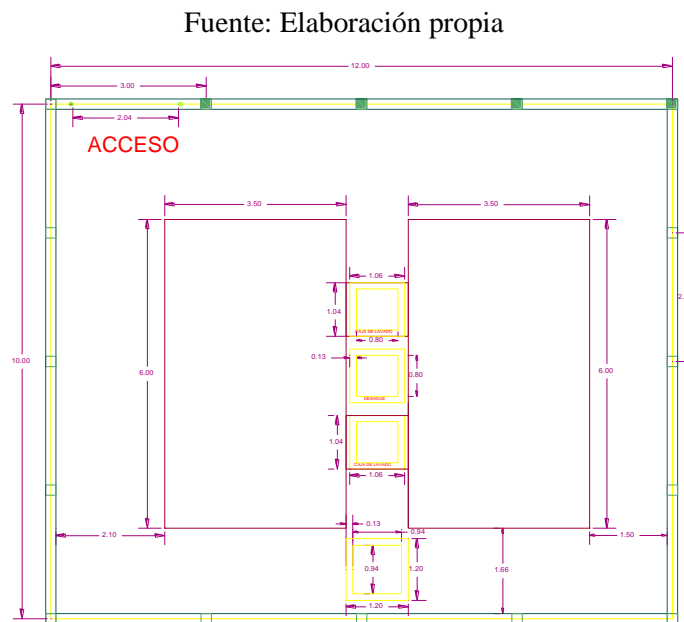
Esquema general obra civil disposición de la planta (dibujo de AUTOCAD .DWG)
